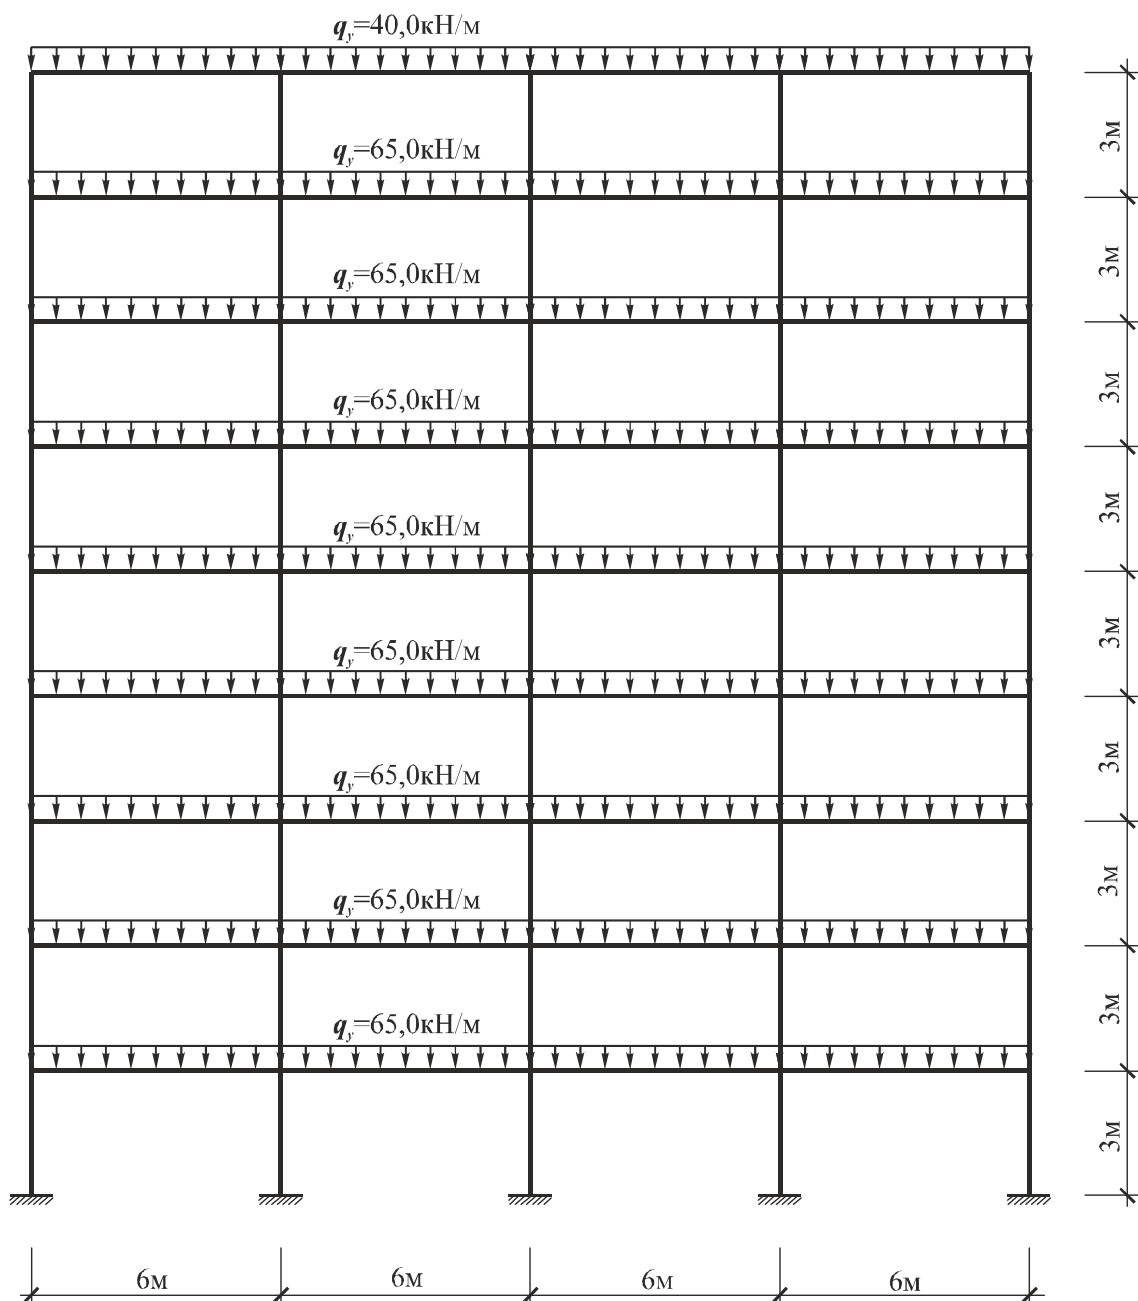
Расчетная схема девятиэтажной четырехпролетной железобетонной рамы на действие постоянной и полезной нагрузки
